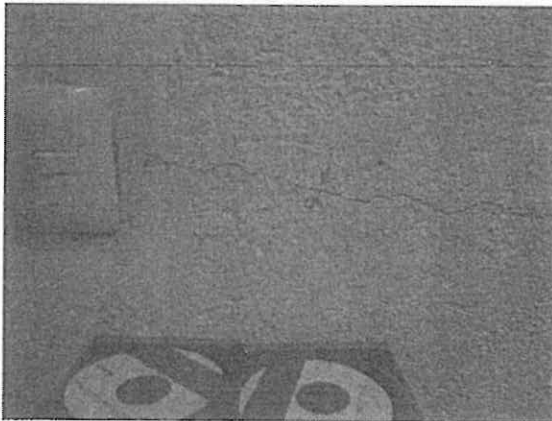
y 20. Fisuras en aplanado de muros de mampostería de la casa hogar para niños, mismas que no representan ningún riesgo estructural, sin embargo se recomienda su sellado.
